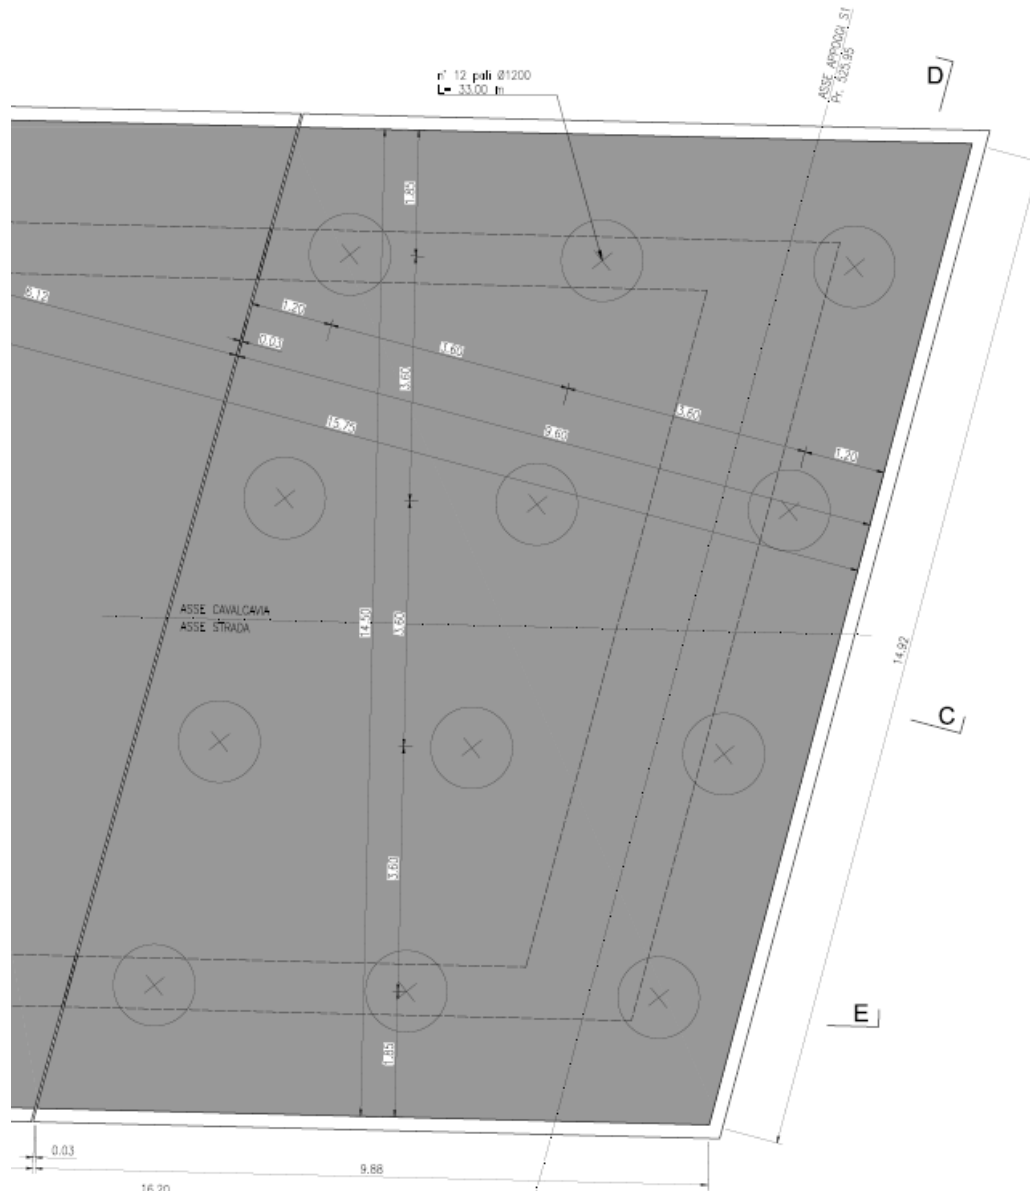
Pianta spiccato pali Spalla S1
